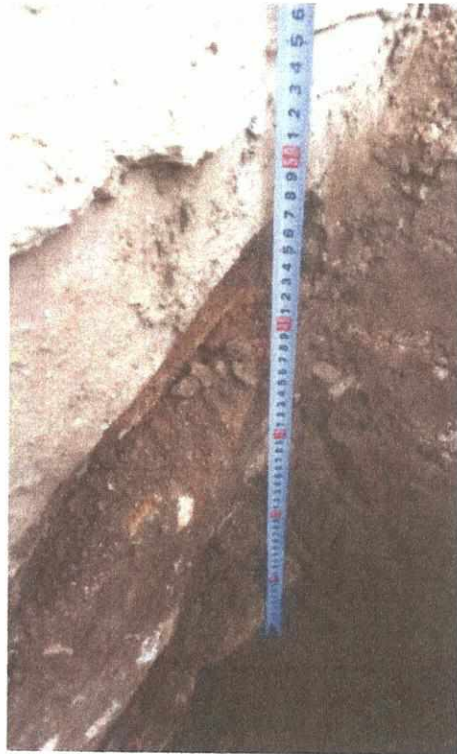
Sondaj realizat pentru determinarea cotei de fundare și determinarea materialelor folosite la fundații
